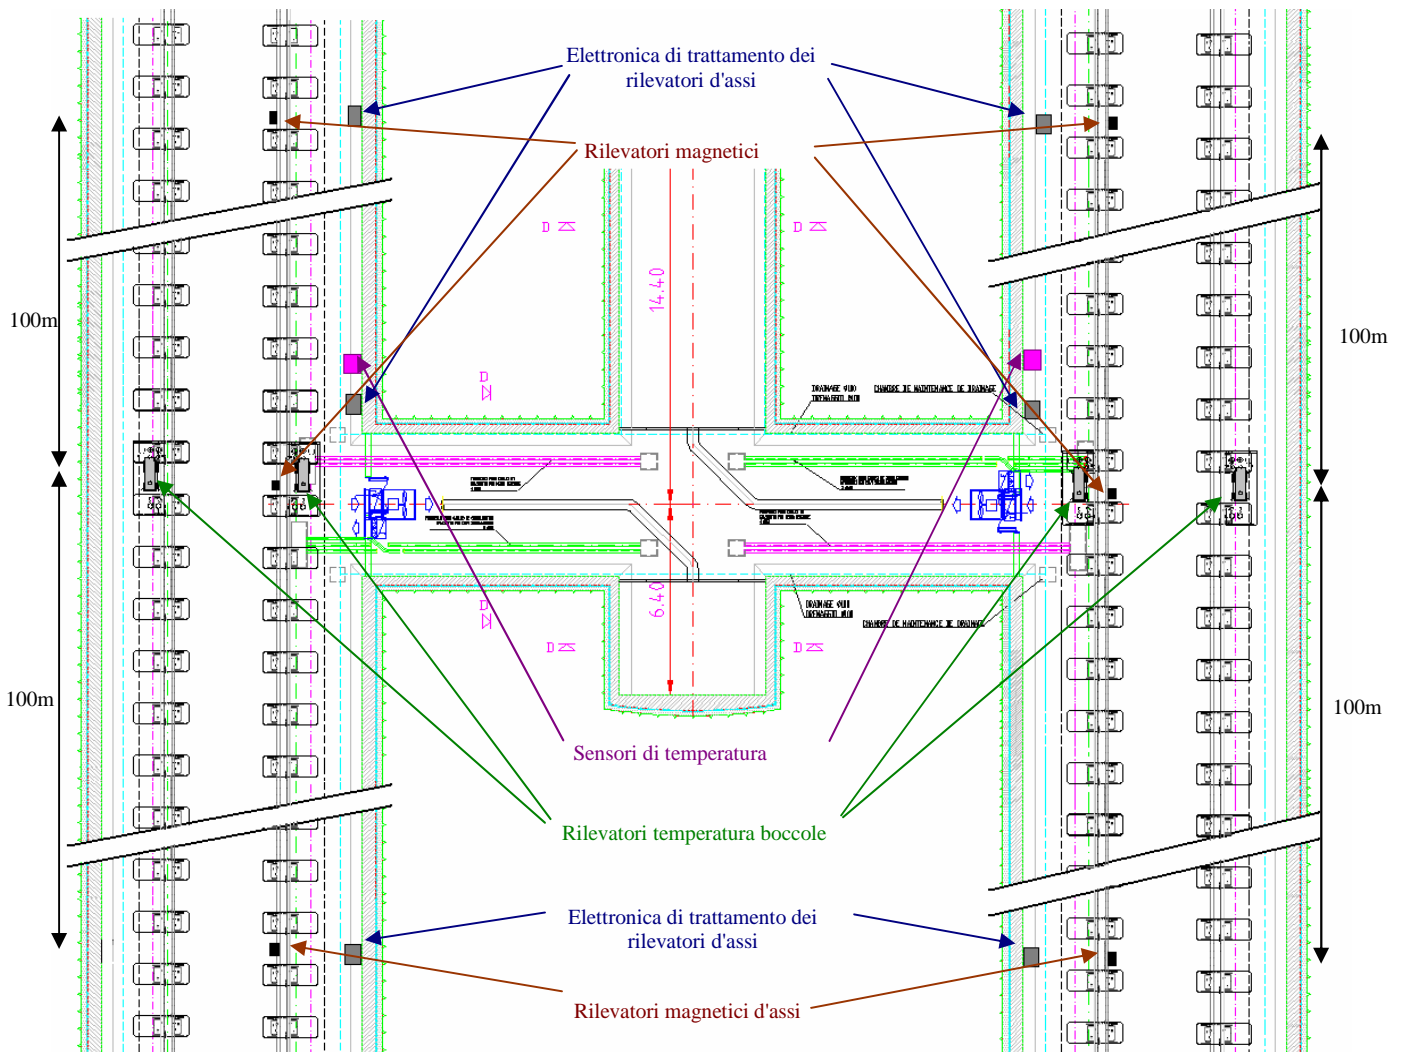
Piano d'impiantazione dei sensori per il sistema di RTB in tunnel
